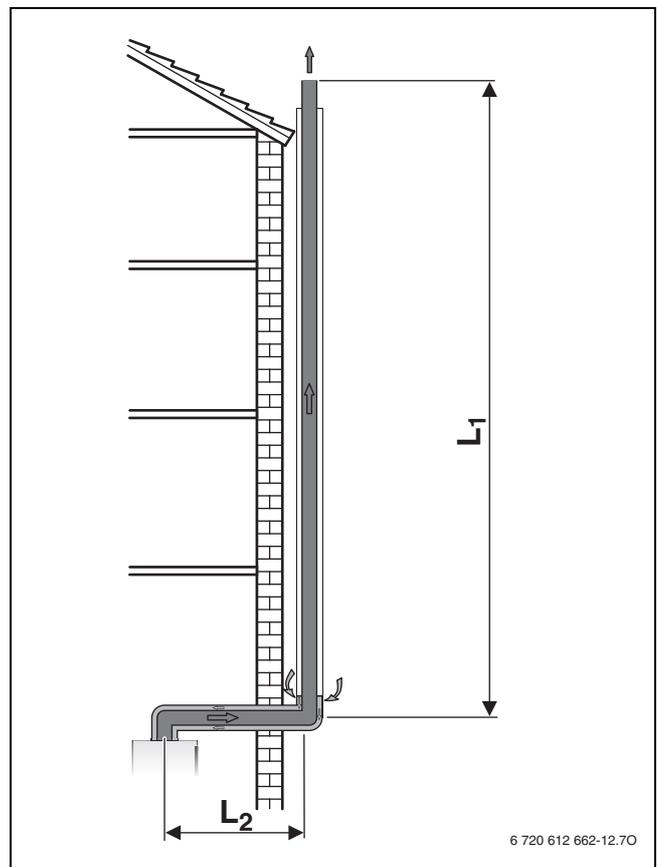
Abgasführung an der Fassade nach C<sub>53x</sub>
